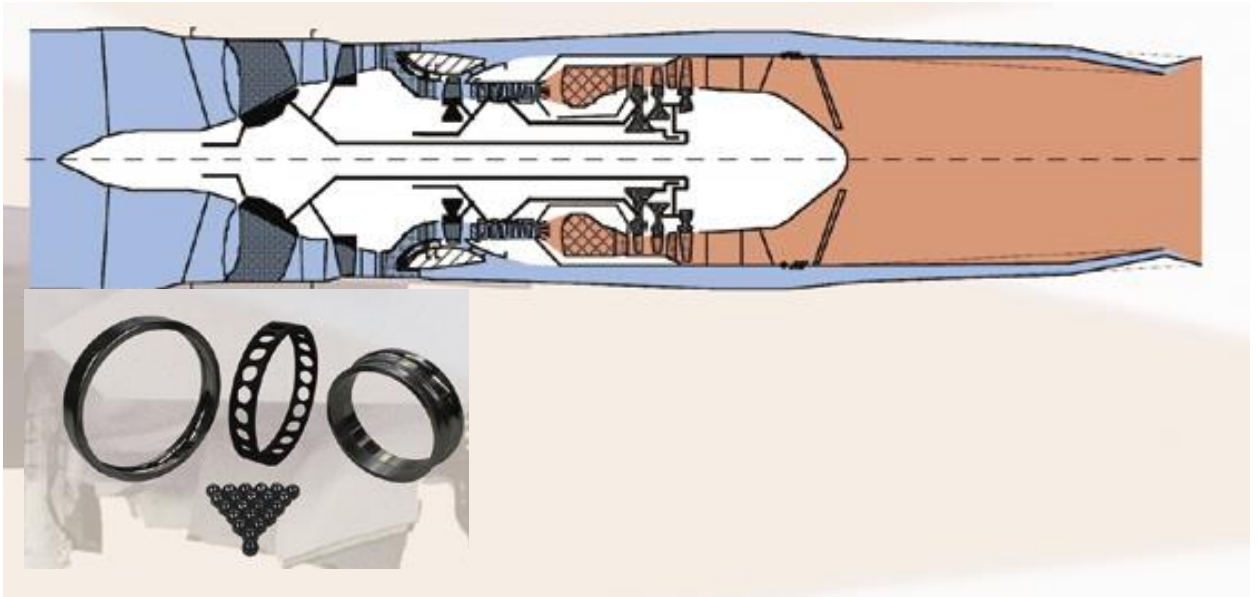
Усовершенствованный газогенератор ХТС77/1 в опорах ротора которого установлены гибридный и магнитный подшипники
